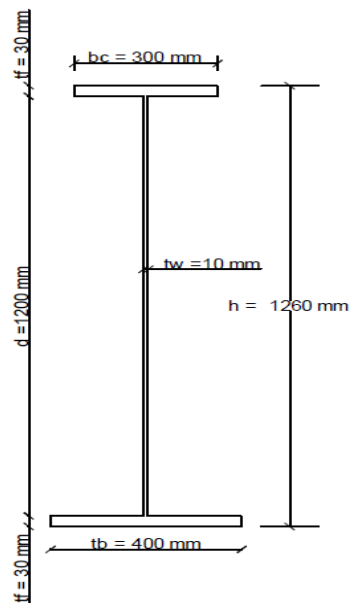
Dimensiones adoptada para la viga central V2. Elaborado por: Autor
